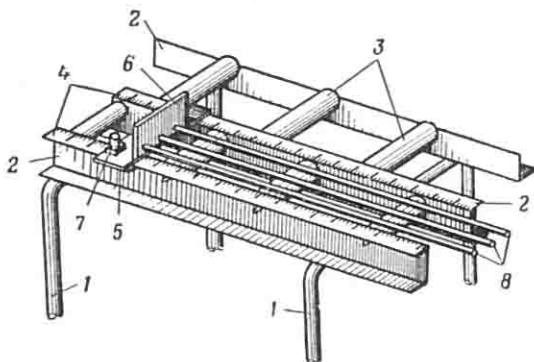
Роликовый стол с передвижным упором-ограничителем для резки тяжелой арматуры на механических пресс-ножницах без предварительной разметки:
